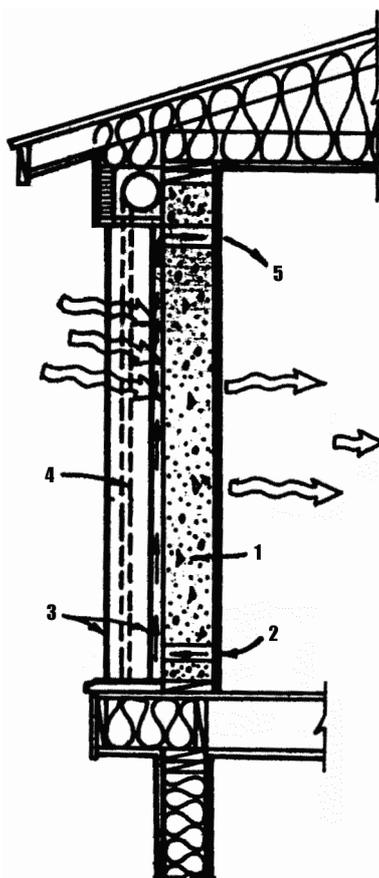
Поперечное сечение южной стены дома фирмы “*Concept Construction*”:
